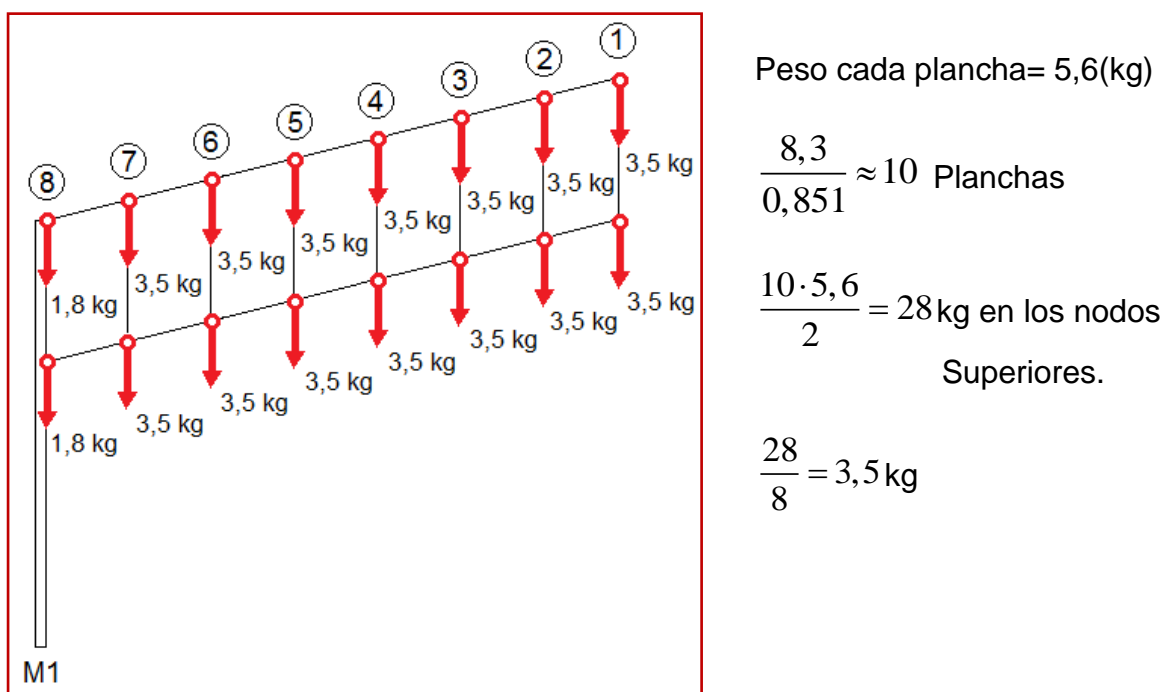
Distribución del peso de las planchas de zinc sobre los apoyos de la parte frontal y posterior.
